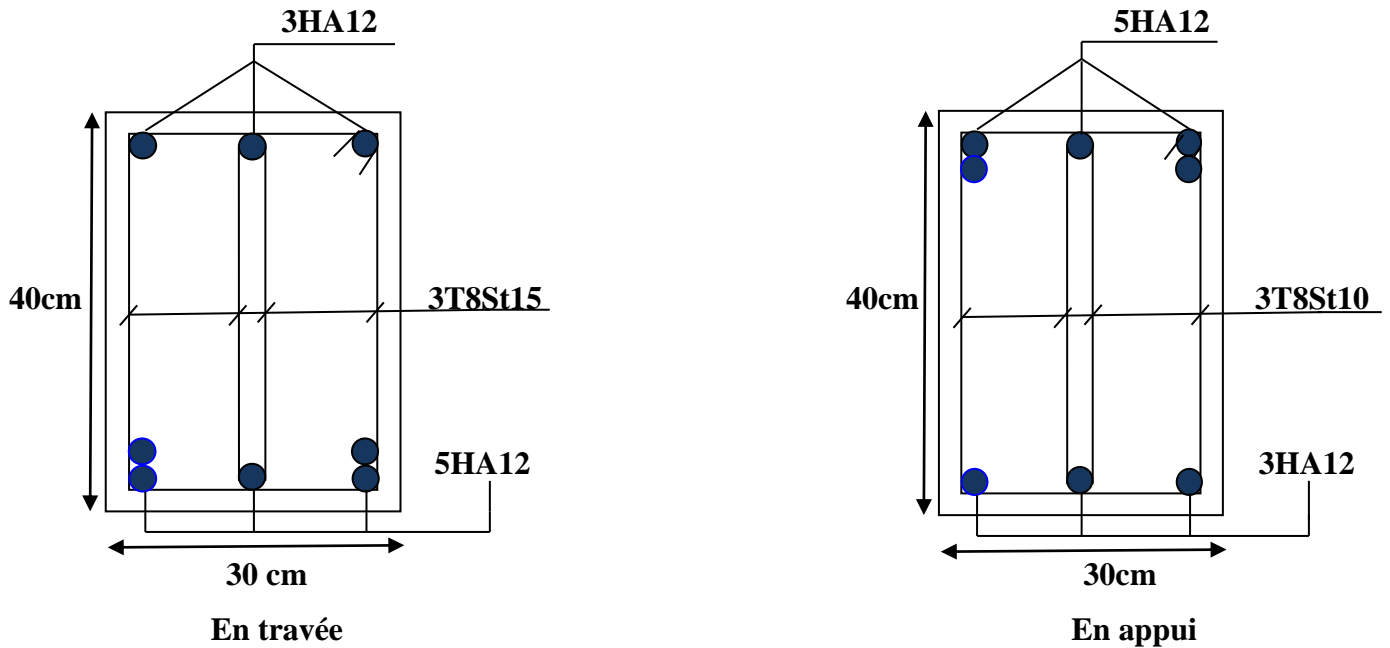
Schéma de ferrailage des poutres secondaires.
